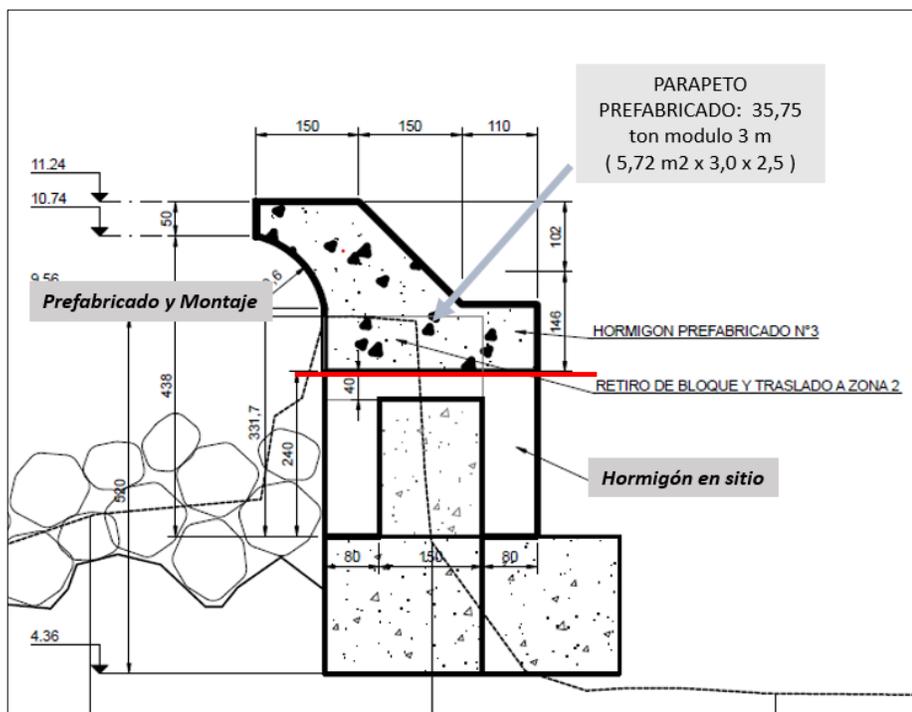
Sección tipo del muro parapeto que muestra hormigonado in situ y elementos prefabricados de hormigón.
